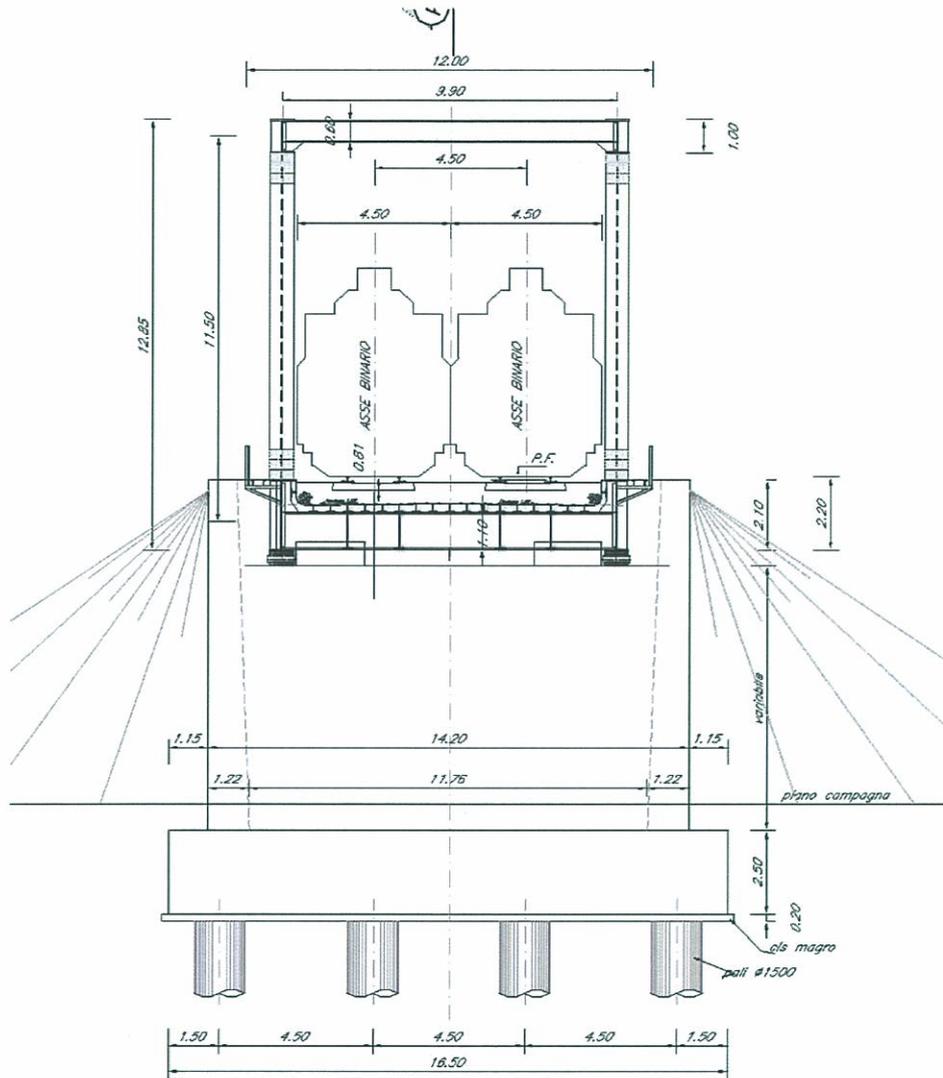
Sezione trasversale in asse appoggi della spalla tipo.
